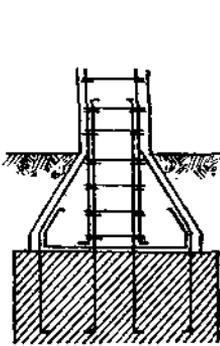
Шарнирная установка стоек железобетонной рамы на нижнем этаже.
